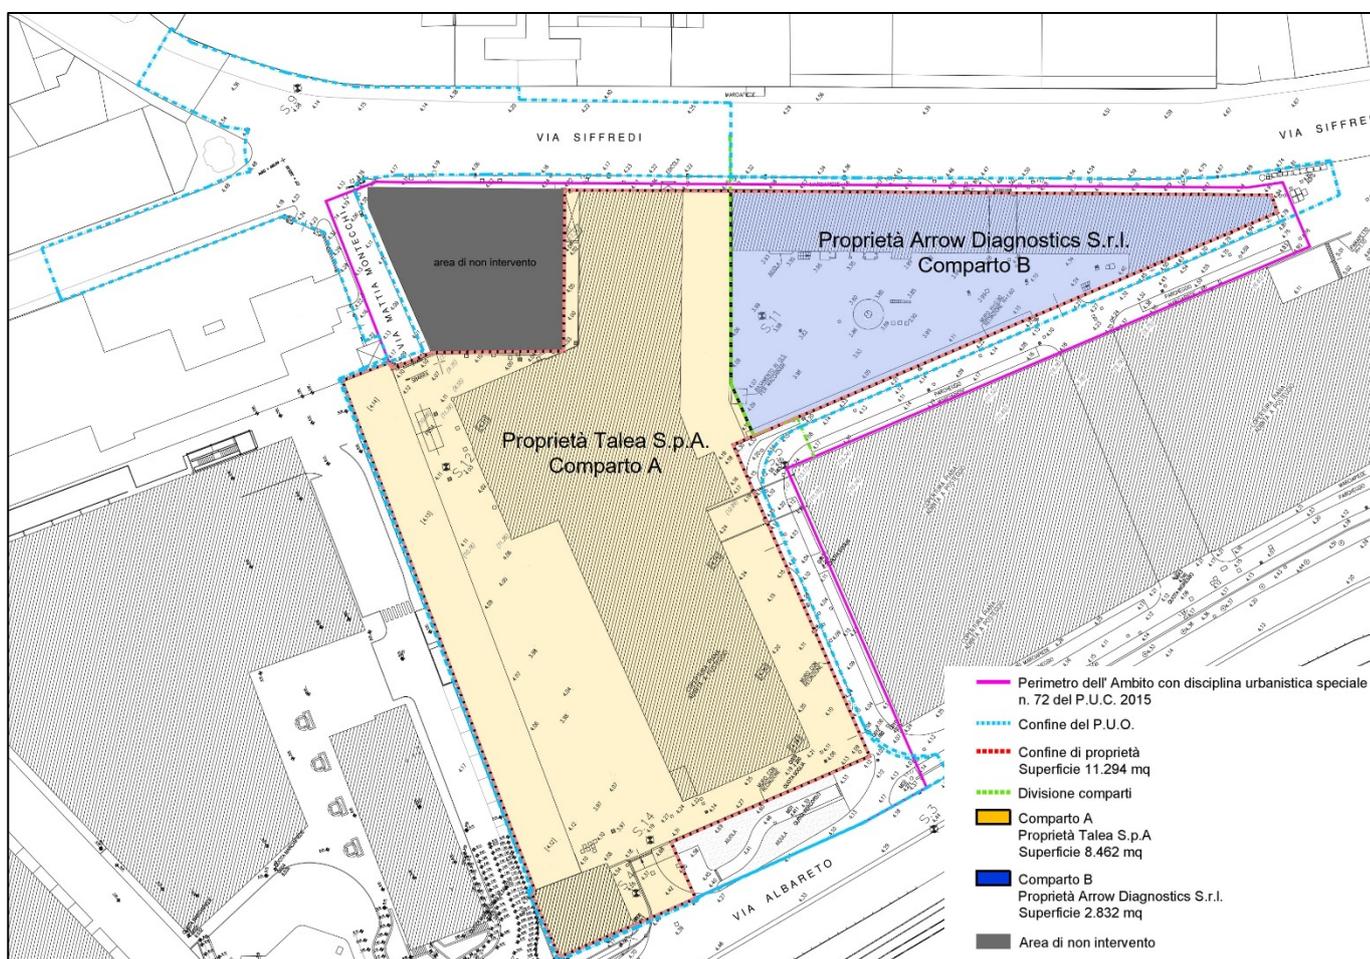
planimetria di rilievo con identificazione delle proprietà
